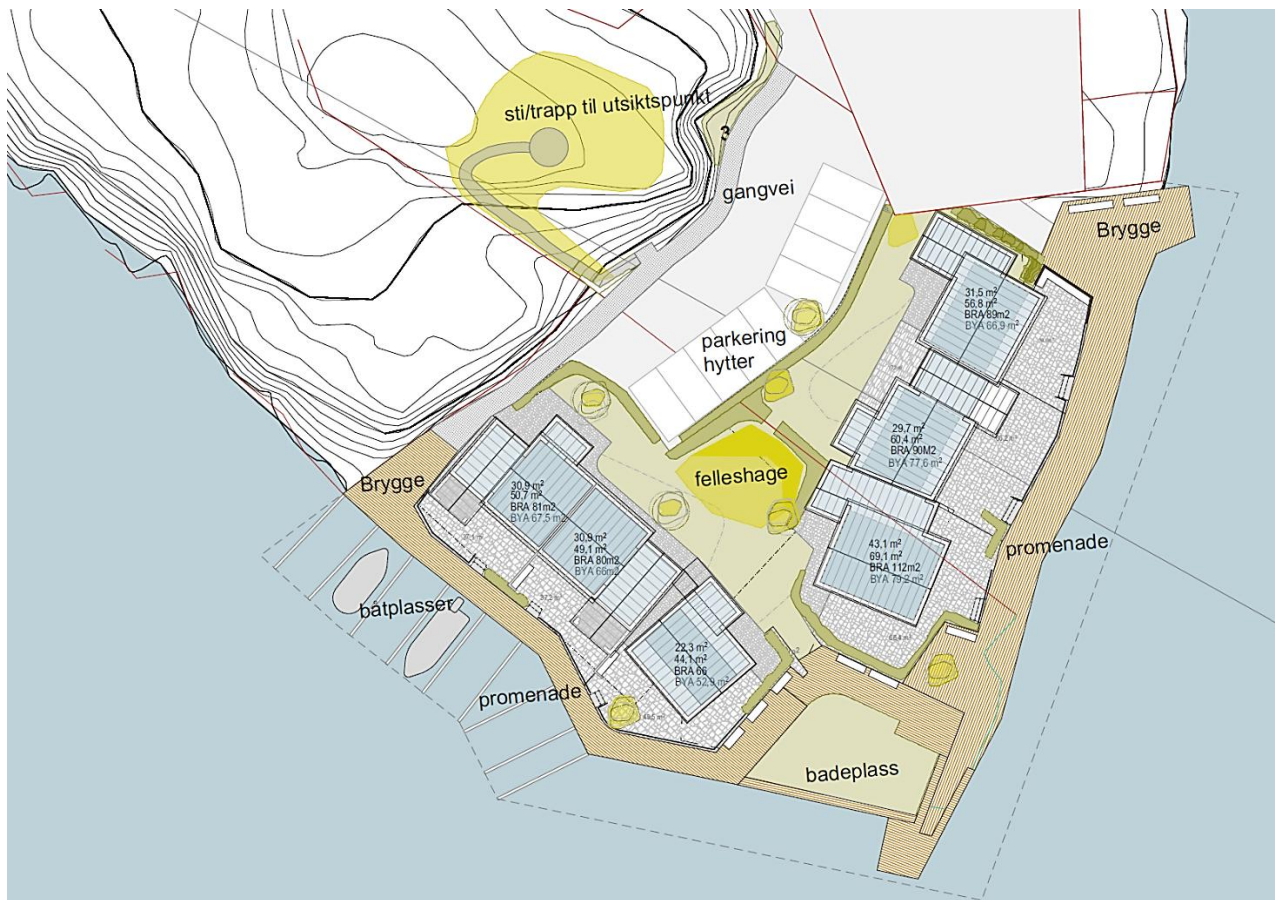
Særtrekk ved bebyggelsen. Kilde: Asplan Viak
